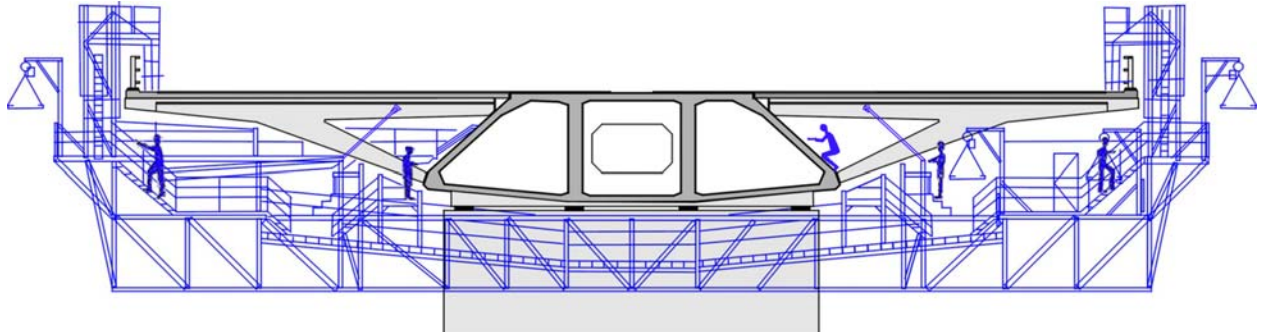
Konstruktion des abgehängten Fahrgerüsts
